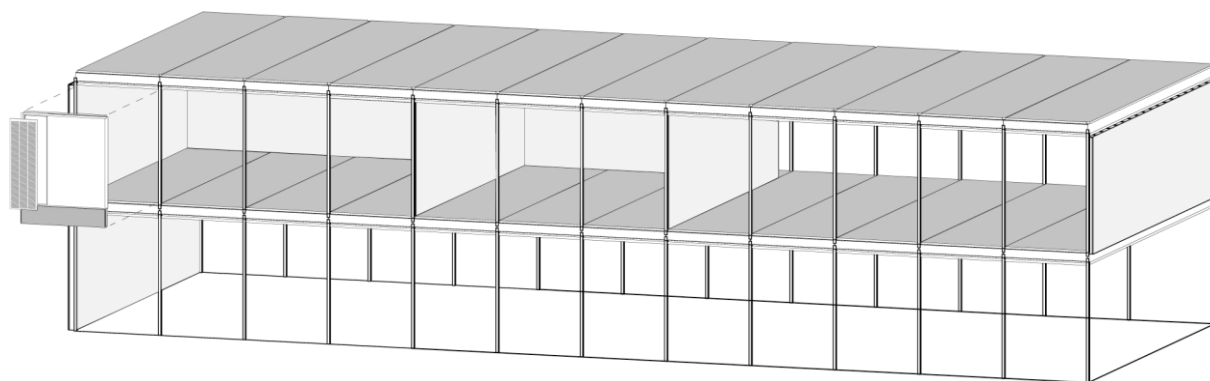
Gebäudeschema mit Decken-/Dachelementen, Stützen und Wänden
